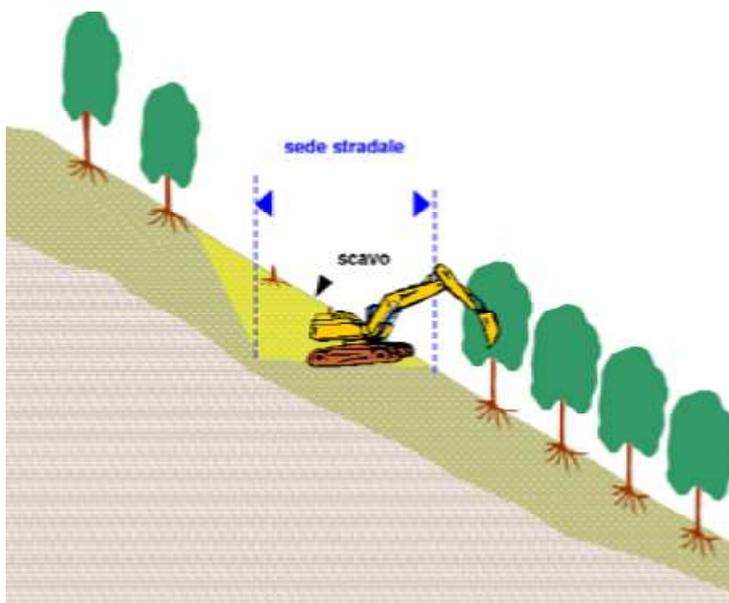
Schema di realizzazione pista di cantiere Tipo II - Scavo.
